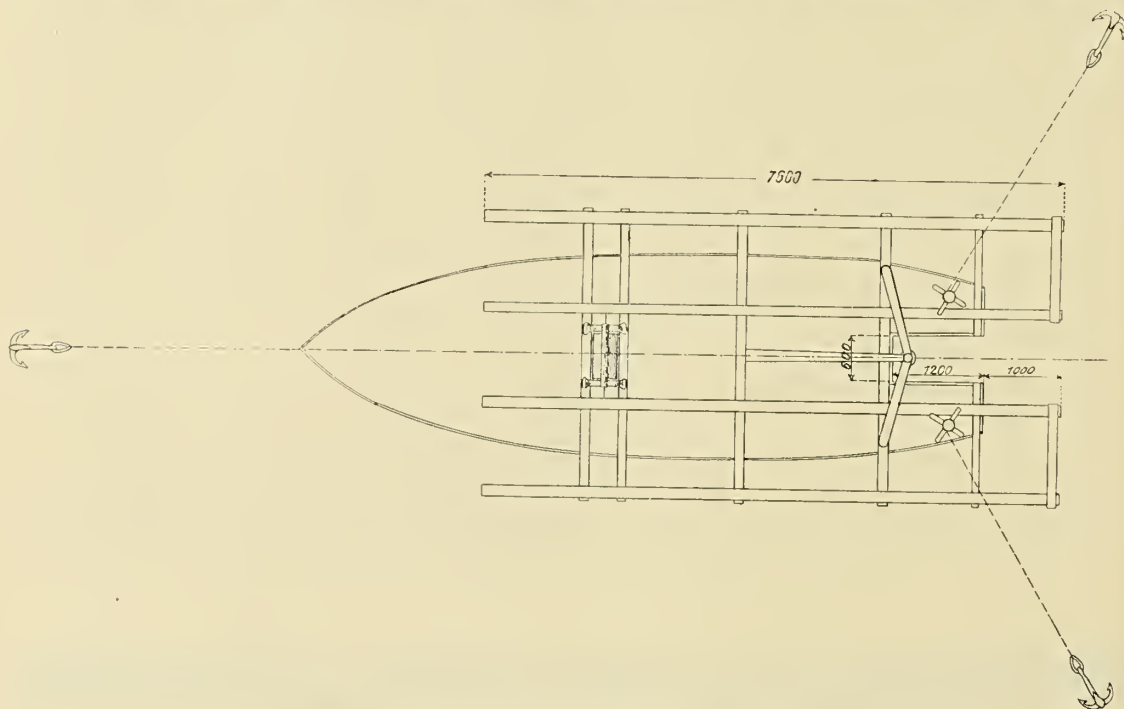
Grundriss des Bohrschiffes. Masstab 1 : 100.
